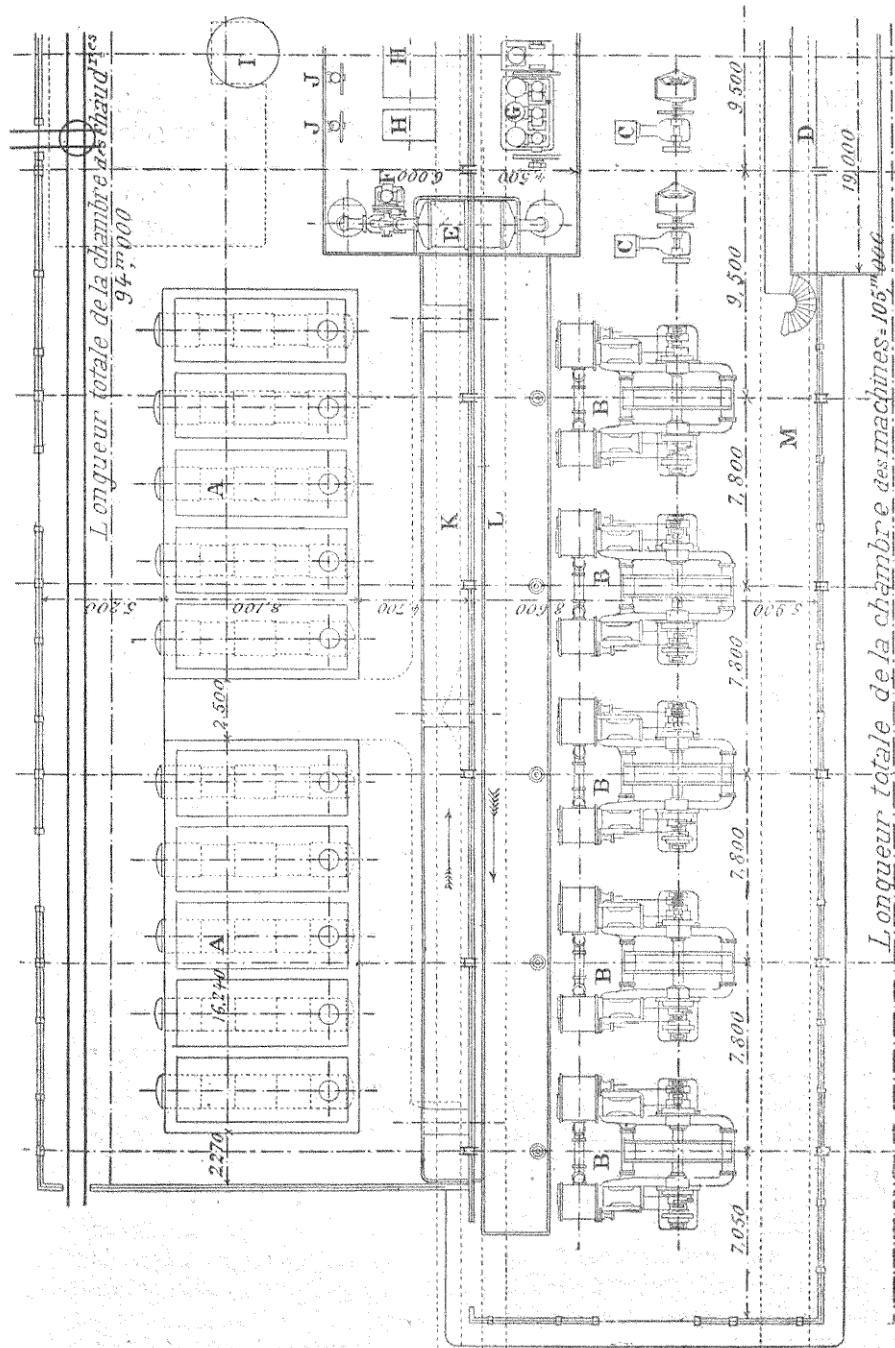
Plan de la station centrale du secteur de la rive gauche.
